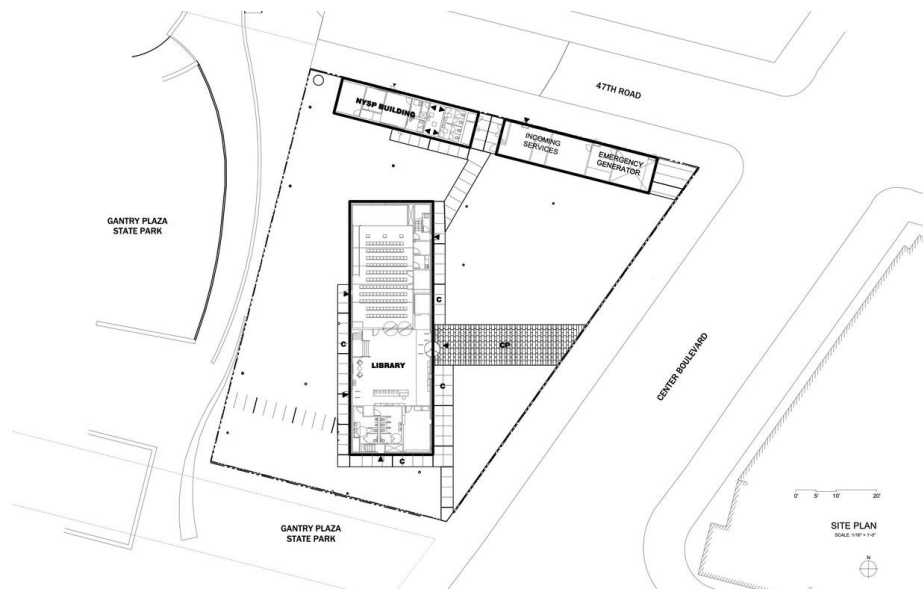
Planta. Biblioteca Hunter Point, Fuente: Steven Holl architects
